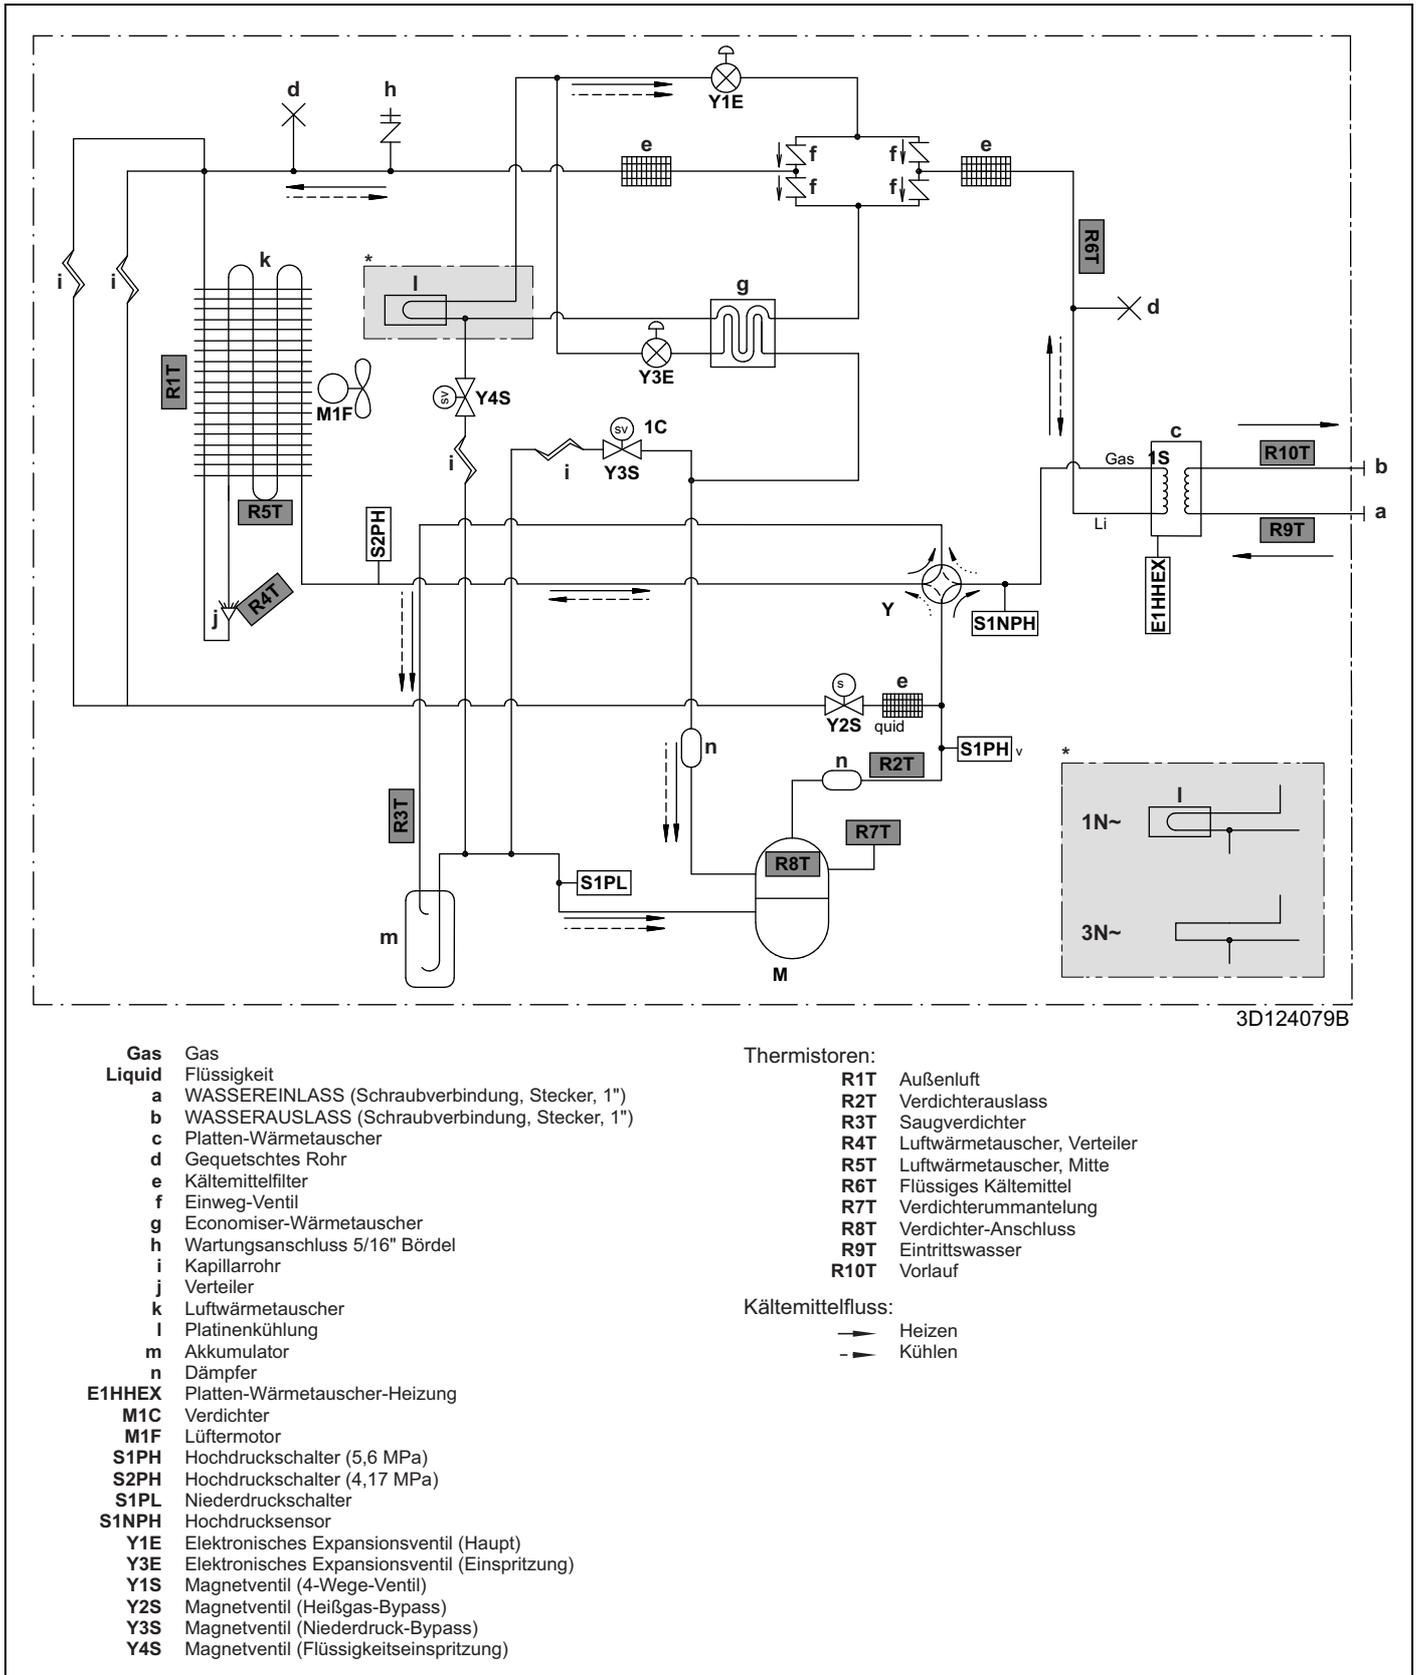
Anschlussplan - Außengeräte EPRA014-018DV
